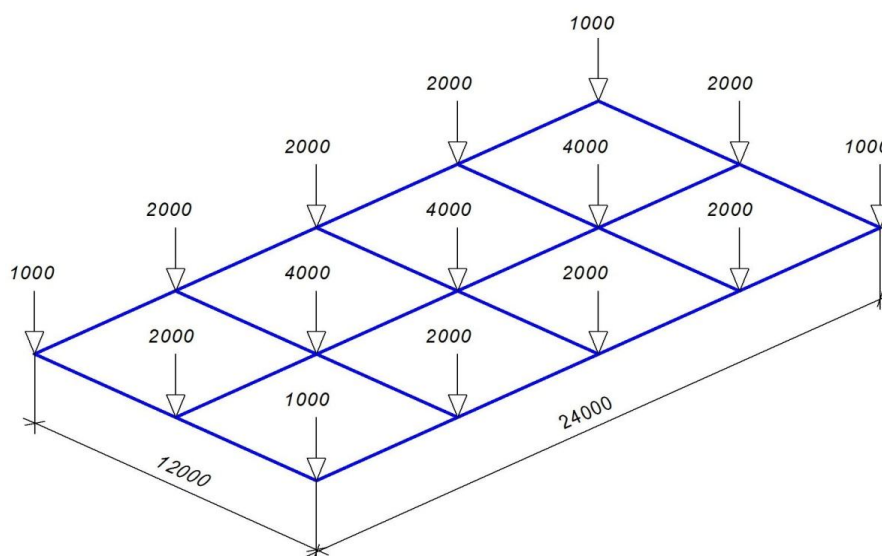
Схема перекрестного фундамента под действием сосредоточенных нагрузок от колонн (в кН)
